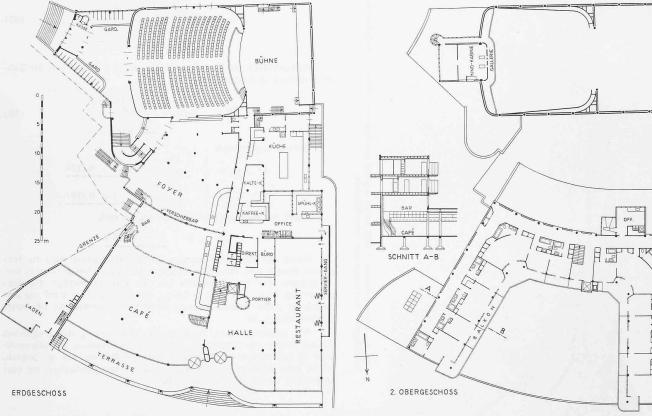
und 2. Grundrisse und Schnitt 1:600 des Grand Hotel Gooi in Hilversum. — Arch. † J. DUIKER.
